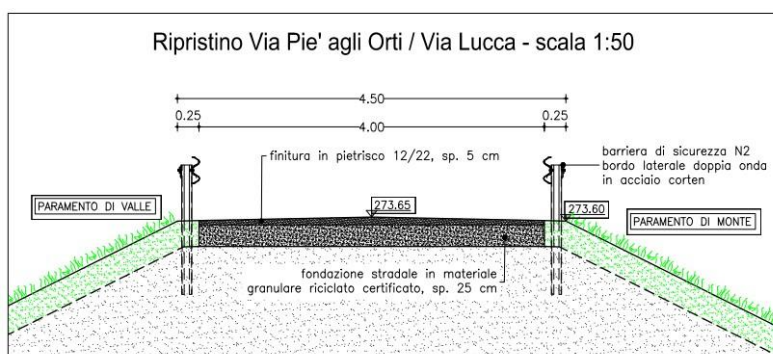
Sezione di dettaglio sommitale del rilevato di sbarramento e della soprastante viabilità.
